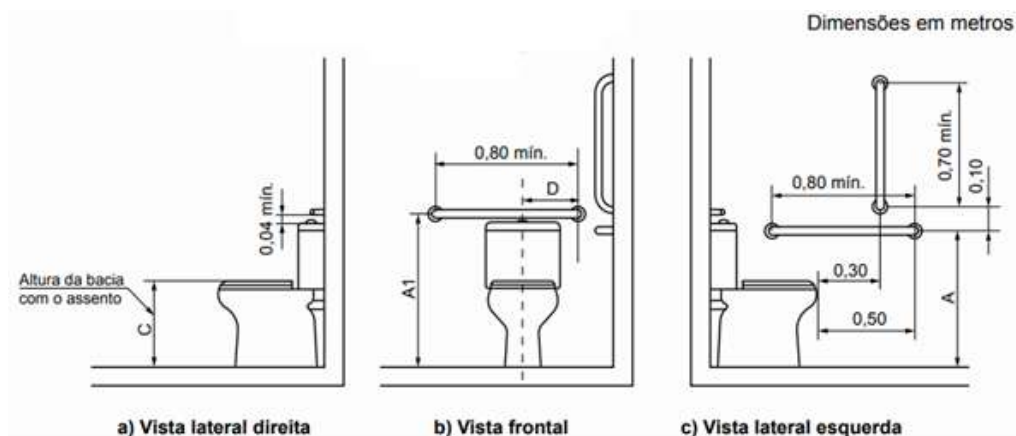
Posição das barras de apoio em relação à bacia sanitária.
